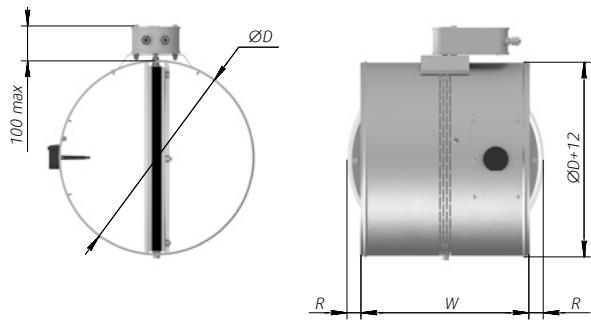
б-1 Размеры ниппельного клапана HELMER 100-560 мм, EI90
